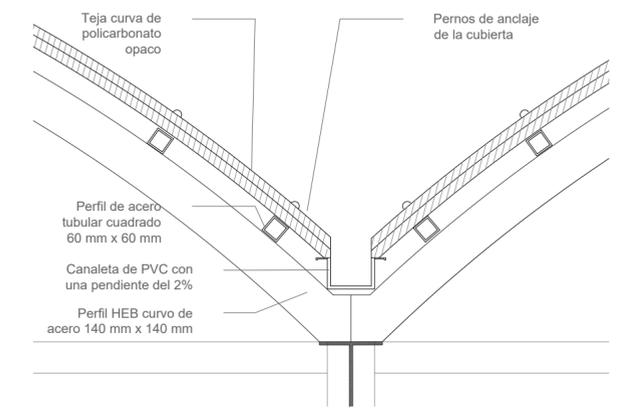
Detalle de la instalación de la canaleta. Fuente: Elaboración propia
